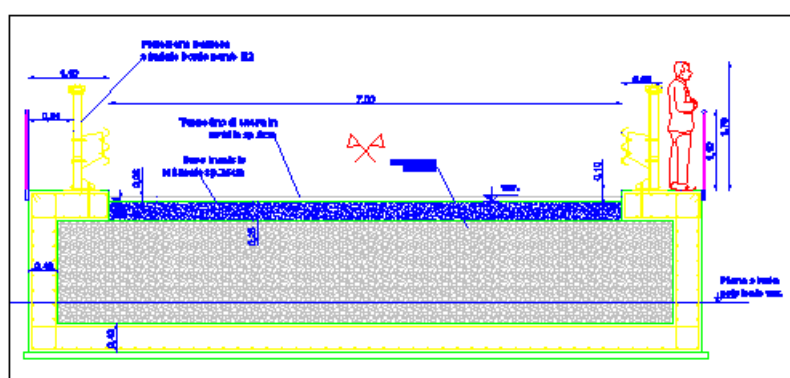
Sezione tipologica rilevato verso piazza S. Giuseppe
